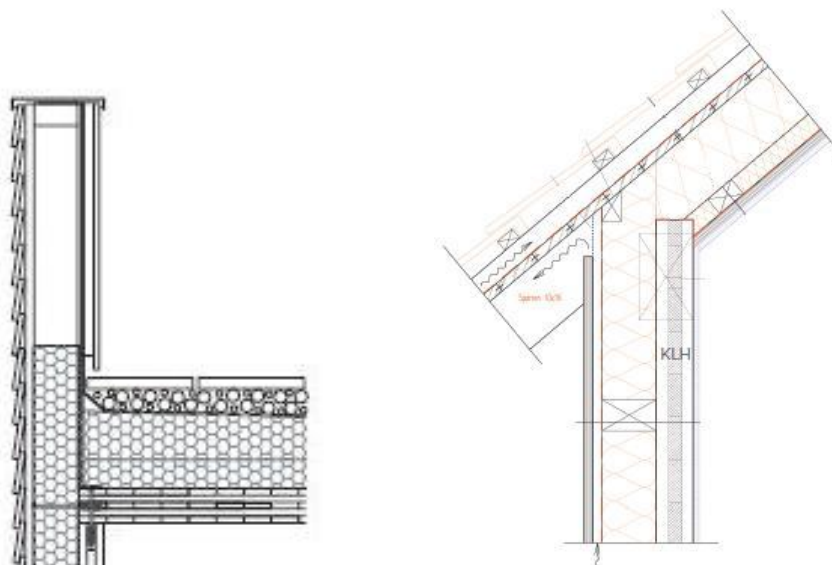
Perfil transversal de soluções em cobertura plana e inclinada [22]
